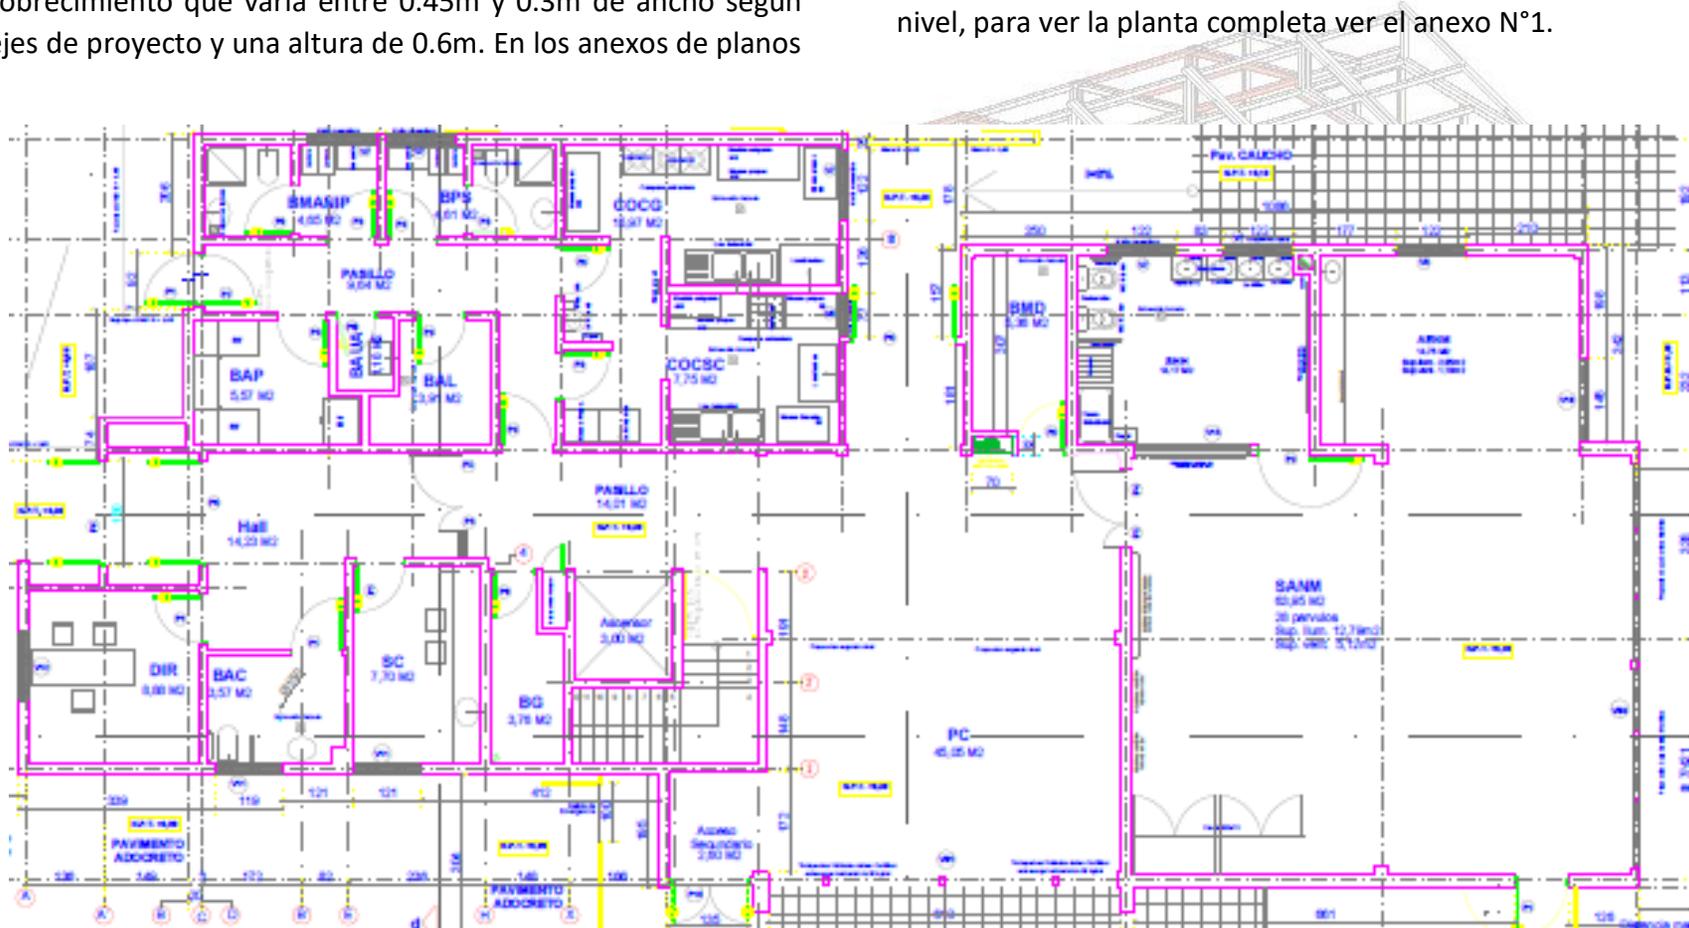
Plano PLANTA PRIMER NIVEL ARQUITECTURA. Fuente Obra Sala Cuna Bosquemar, Constructora Molina Asenjo, Mirasol Puerto Montt.
